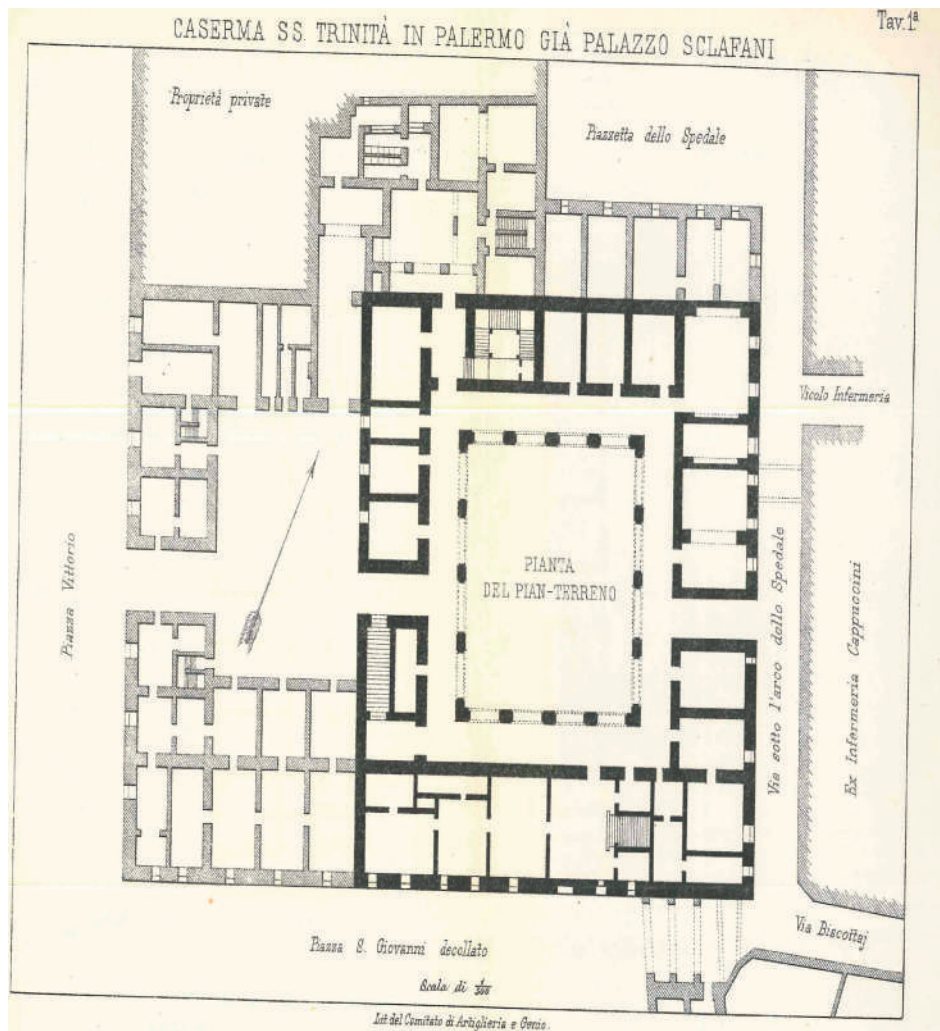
Palermo, Ospedale Grande, pianta del piano terra con perimetri originari realizzata in occasione di lavori di restauro della facciata nel 1881 (foto da BRINI 1885: tav. I).
